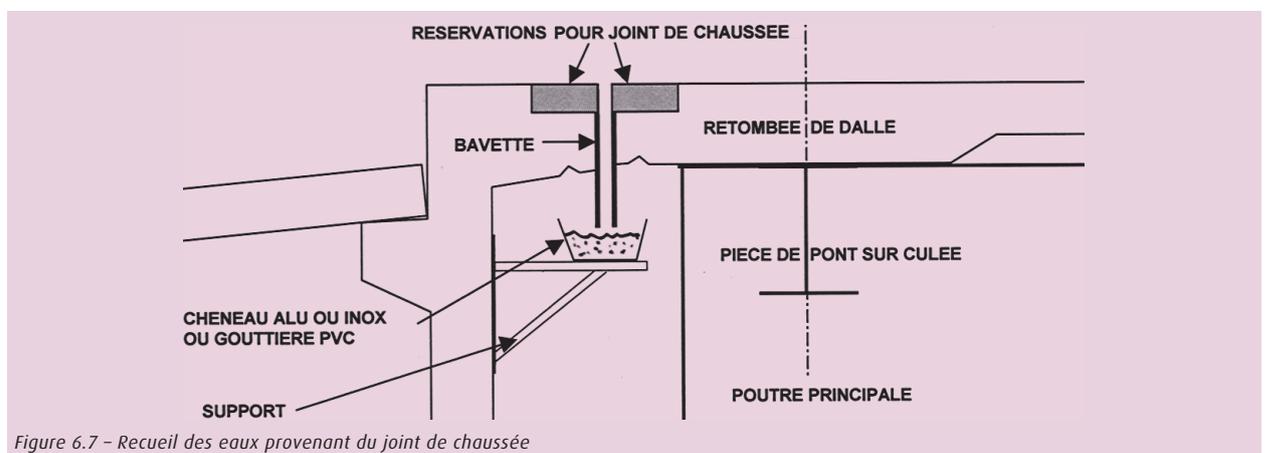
Recueil des eaux provenant du joint de chaussée
